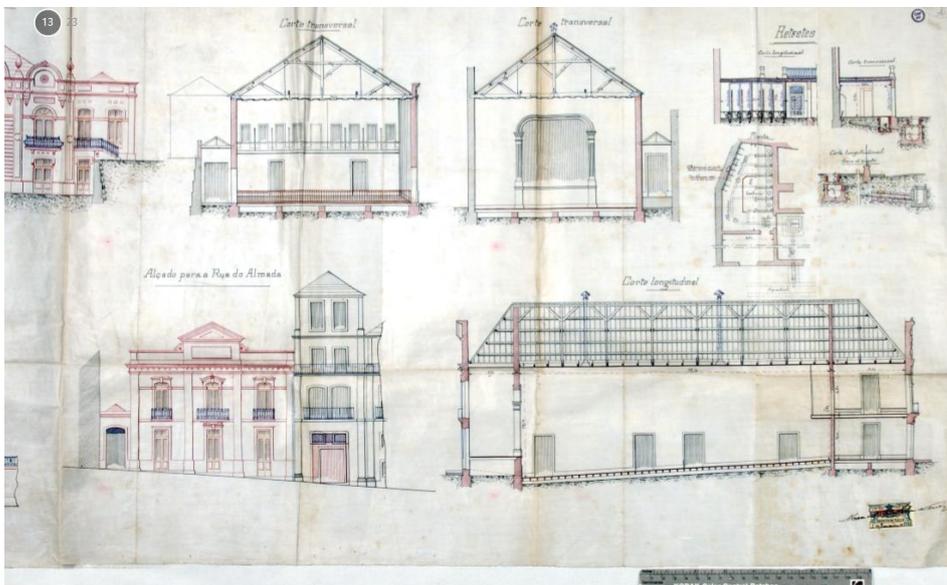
Cortes transversais com vista para os camarotes e palco, respetivamente. Corte longitudinal e alçado para a Rua do Almada
